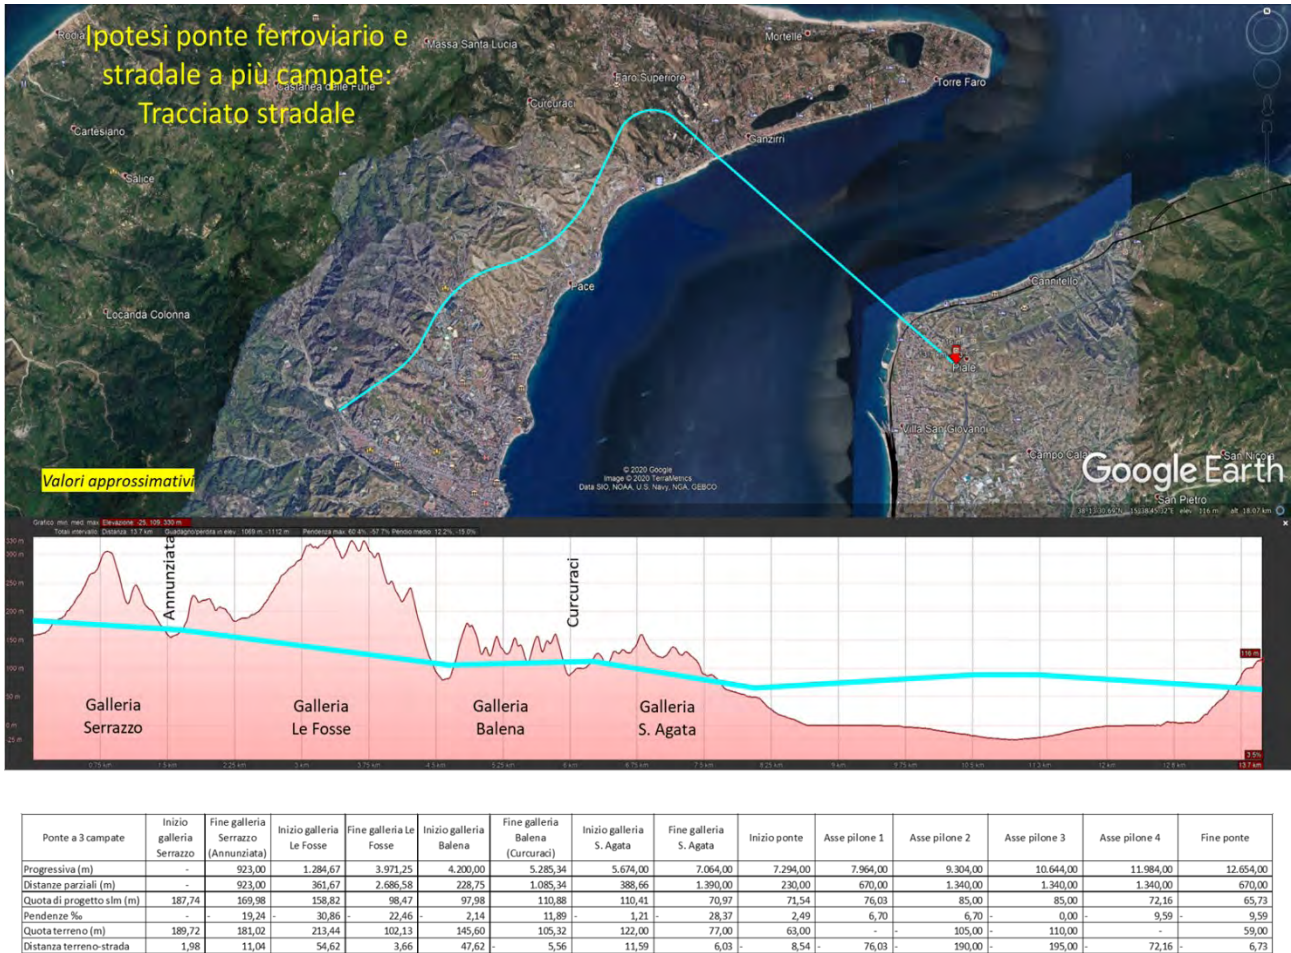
Ponte a più campate - Tracciato autostradale – Caratteristiche plano-altimetriche
